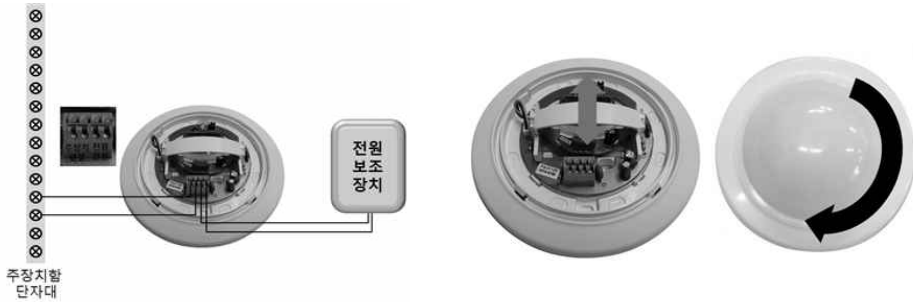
열선 감지기 PCB 및 단자대결선
